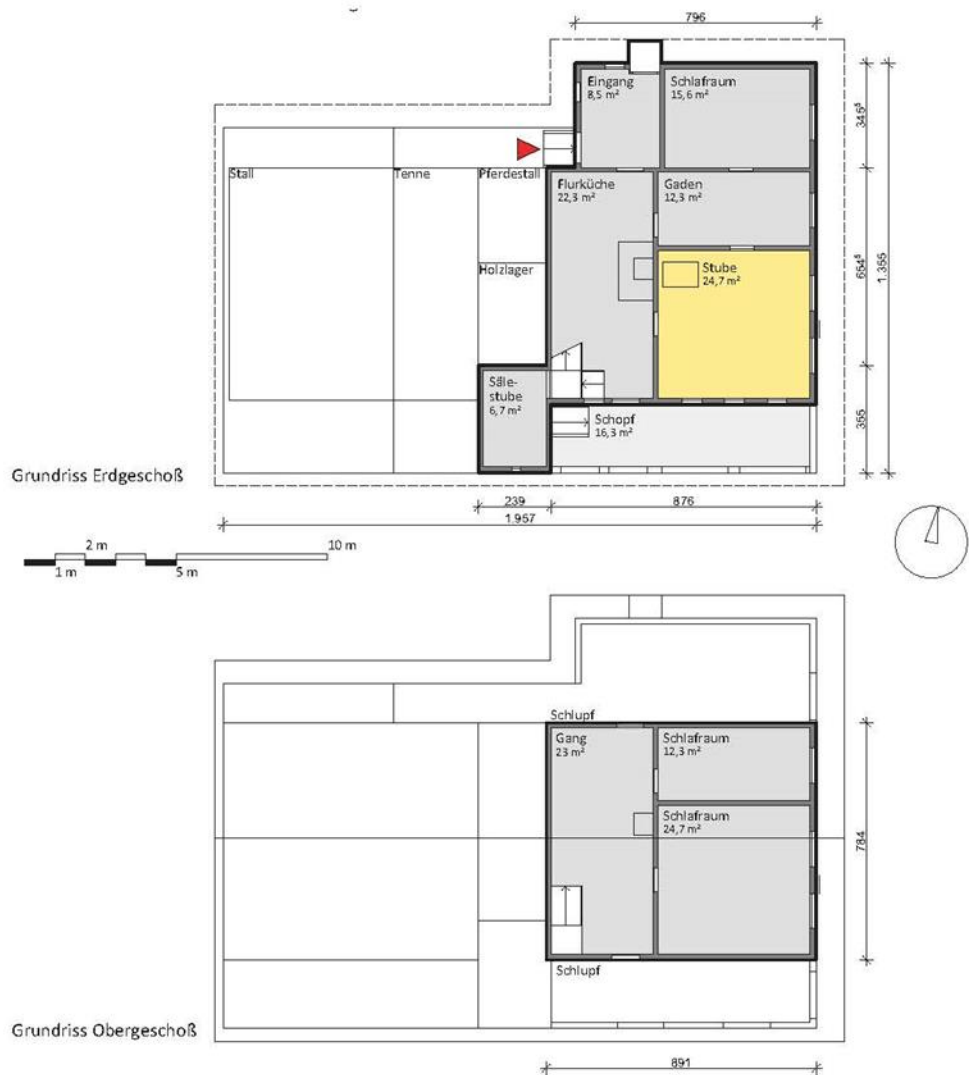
Grundrissdarstellung von Erd- und Obergeschoß des Wohnbereiches
